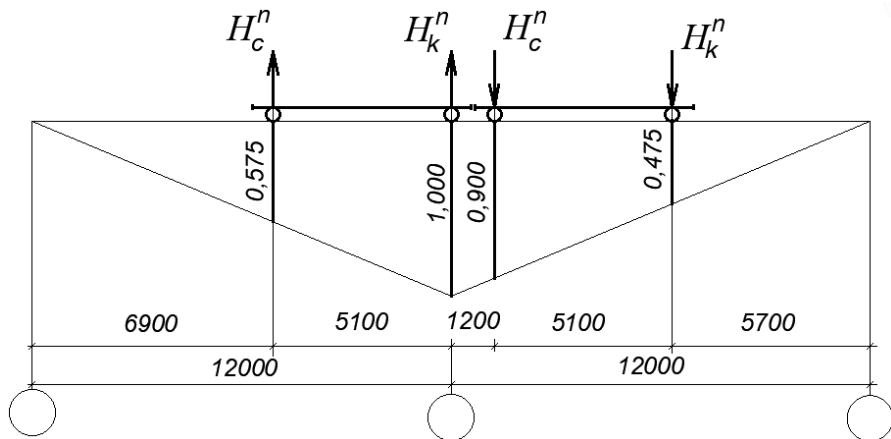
Схема для визначення горизонтальних кранових бічних навантажень від двох зближених кранів на середню опору за другим рекомендованим варіантом для лівої сторони крана
